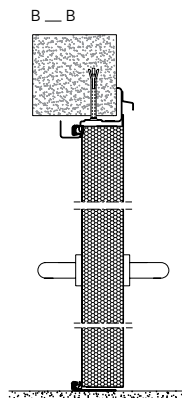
Vertikalschnitt Stahlaußentüren ECO, mit Eckzarge
